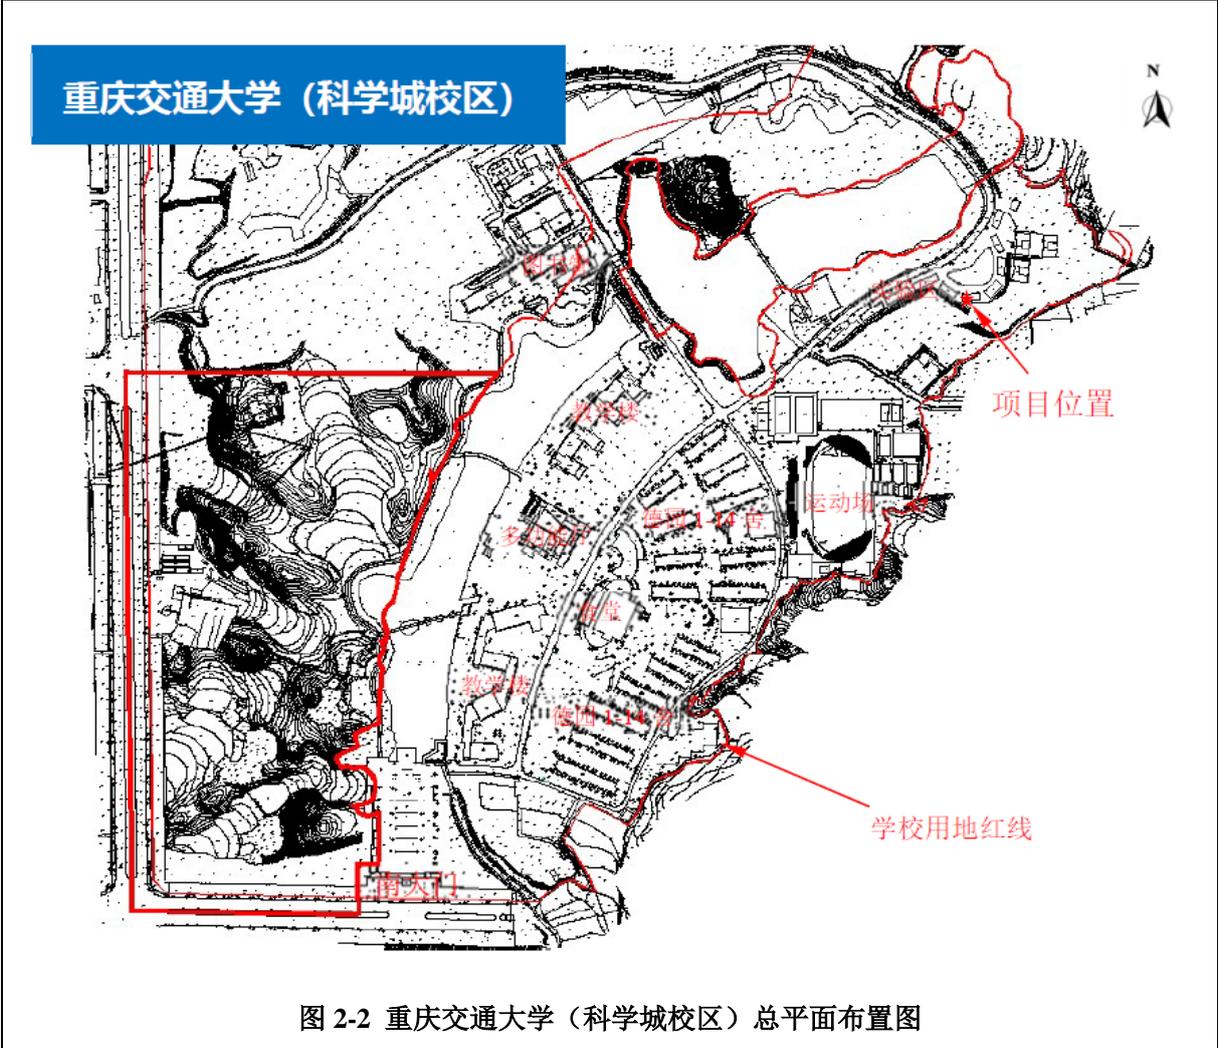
重庆交通大学 (科学城校区) 总平面布置图
